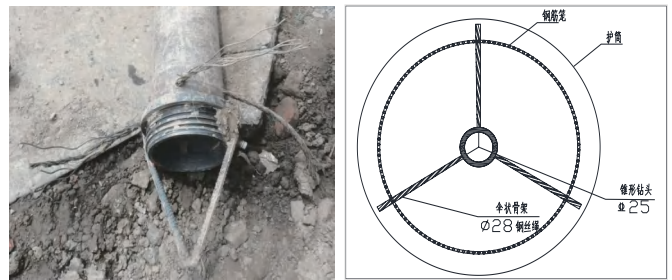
自制轻型扫孔钻头及柔性钻头平面布置图
